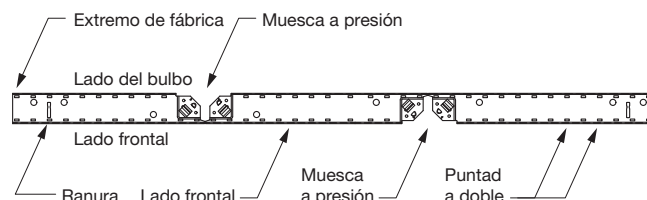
Detalle del SimpleSoffit recto con luz empotrada
